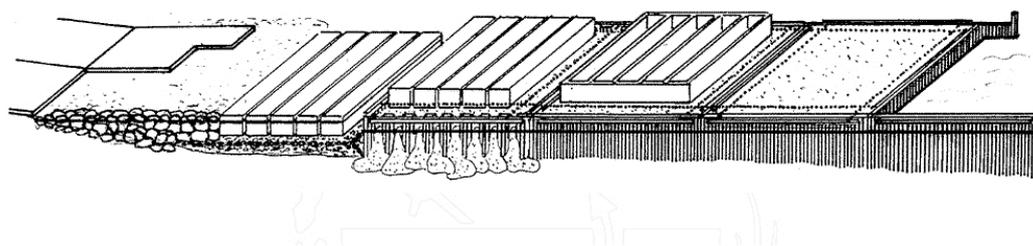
Fase constructiva de un dique de bloques de hormigón usando banqueta de escollera y recintos tablestacados.
